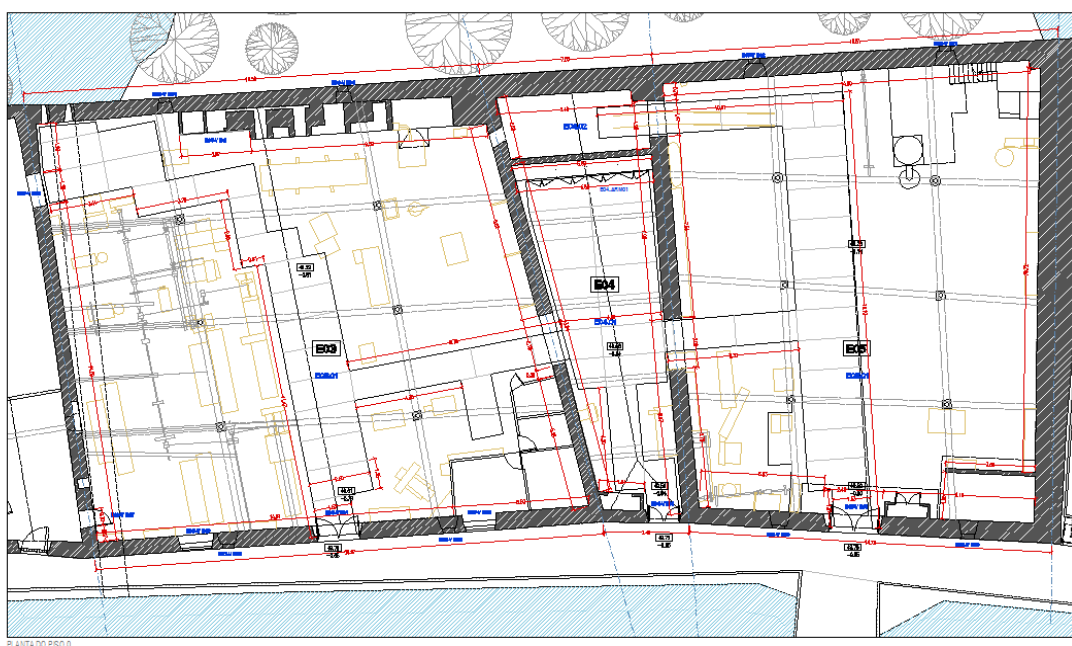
Planta do sector em estudo. (CCG Arquitectos Lda.).
